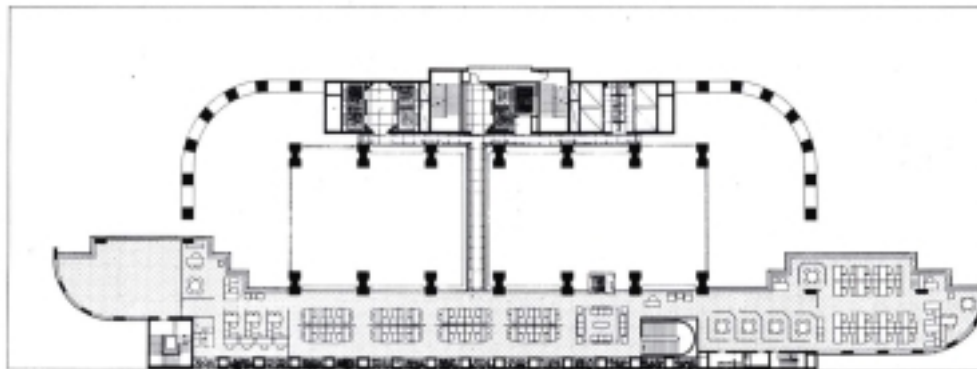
Planta sobreloja – nível avenida Paulista
